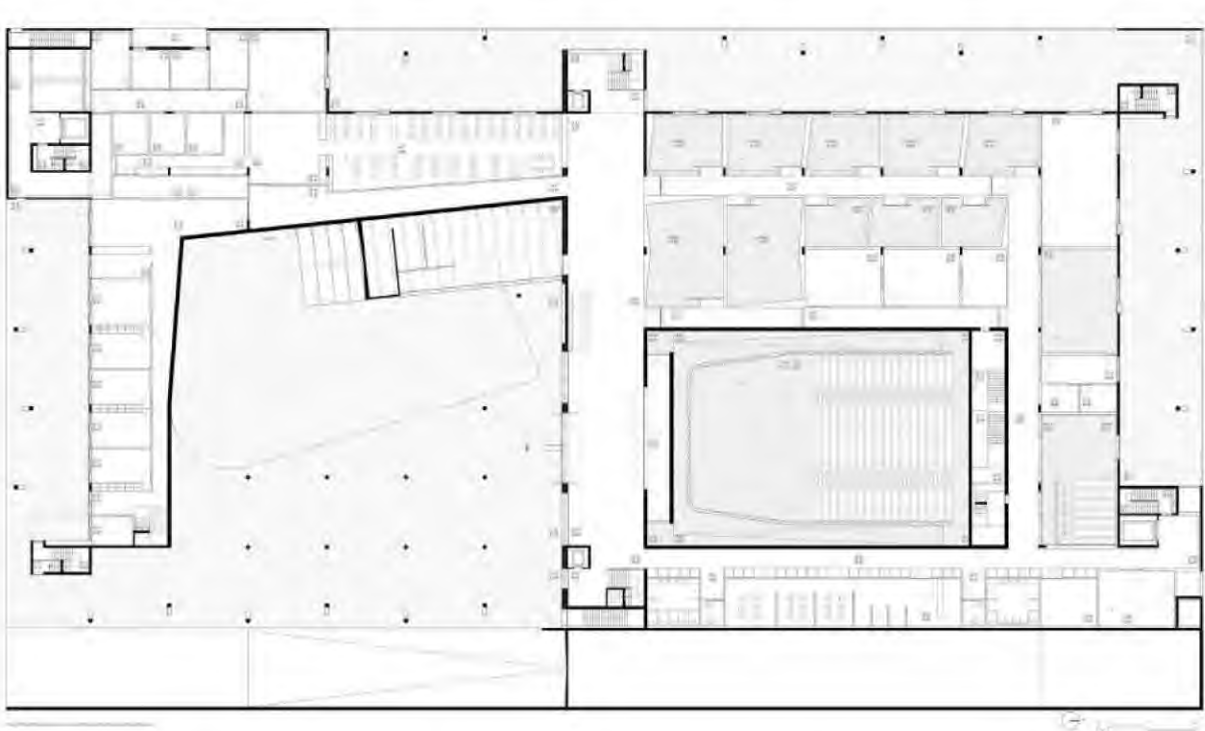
Escola de música de Lisboa - Planta Baja. Fuente: João Luís Carrilho da Graça (2008).
